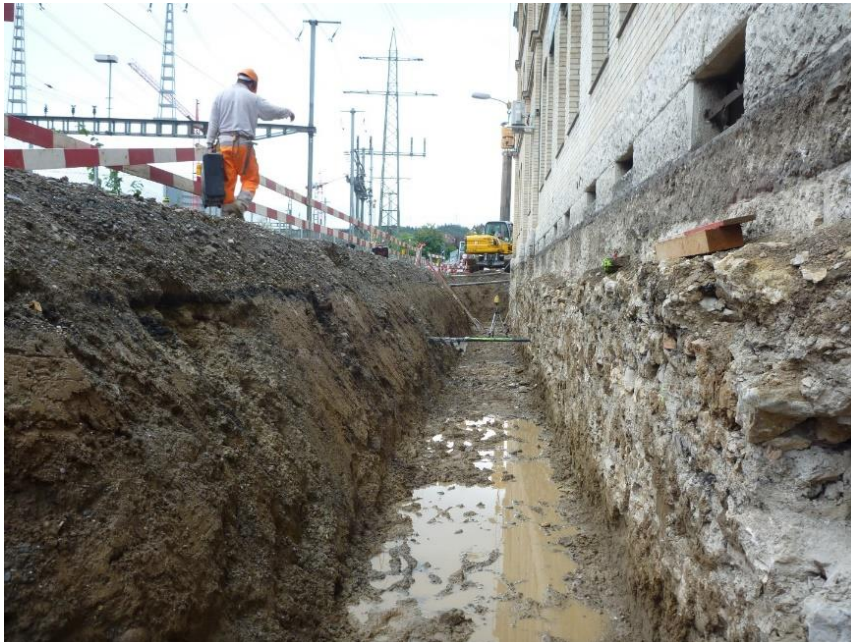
, Excavación para zona de trajo e inspección del muro perimetral
